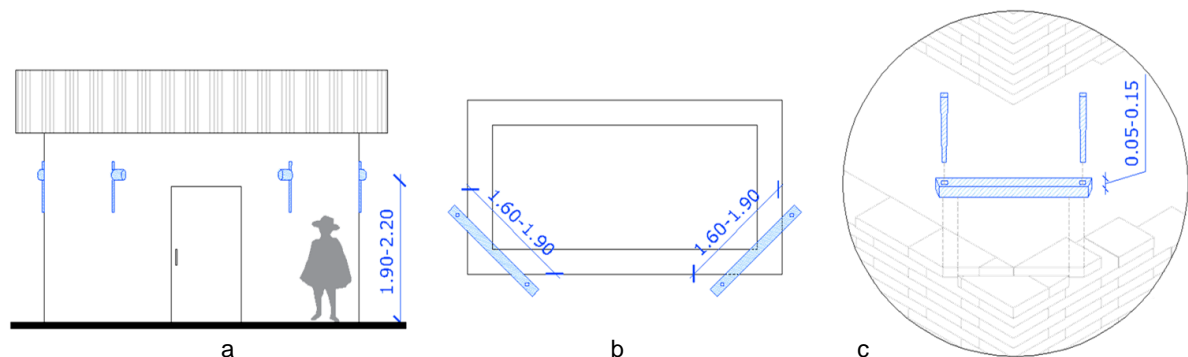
a) Dispositivo DE instalado a la altura del dintel. b) Dimensiones de dispositivos en planta c) Detalle de dispositivo sección rectangular
